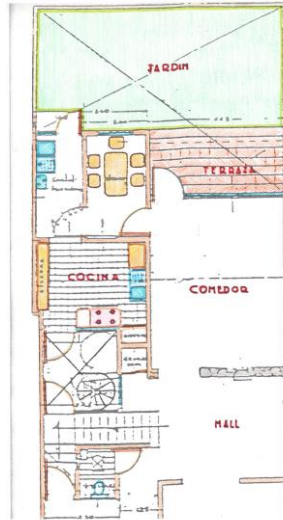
Plano de casa habitación. Planta Baja, arquitecta María Luisa Dehesa
